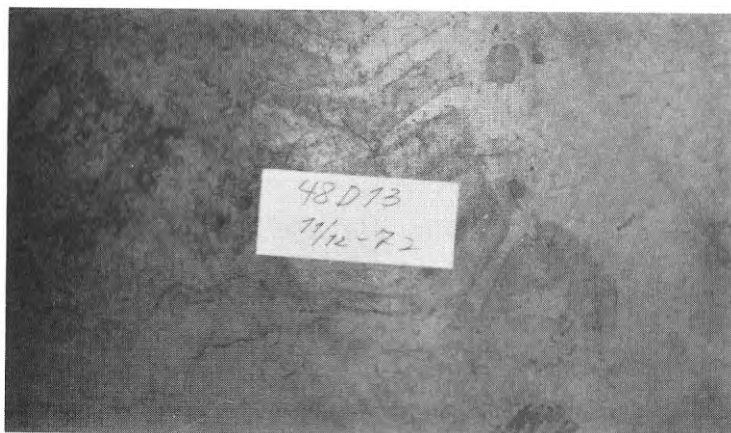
Fluat, betonggolv i lasthall, 3 år.
